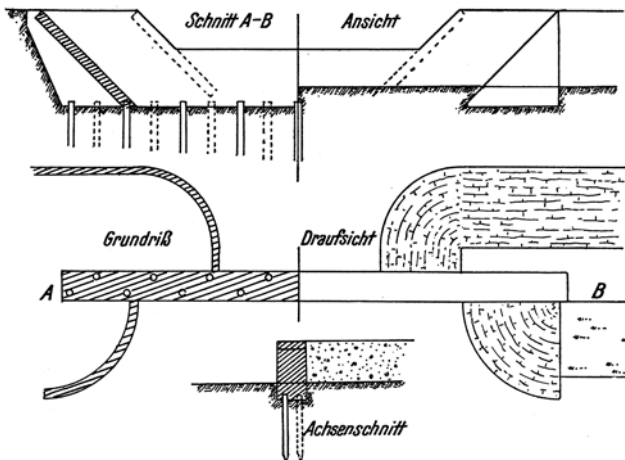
Betonchwelle mit Flügeldämmen, bayrische Type.
